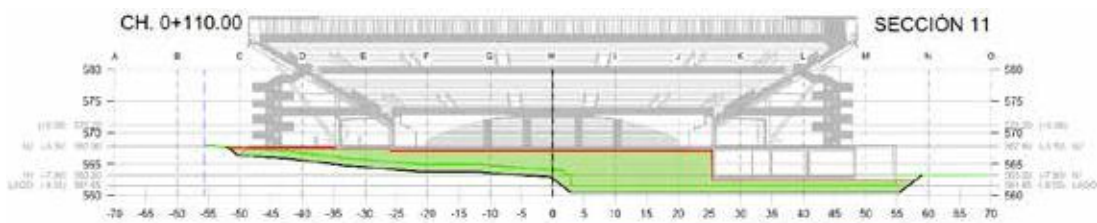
Sección transversal de excavación y rellenos. Centro del estadio circular.
